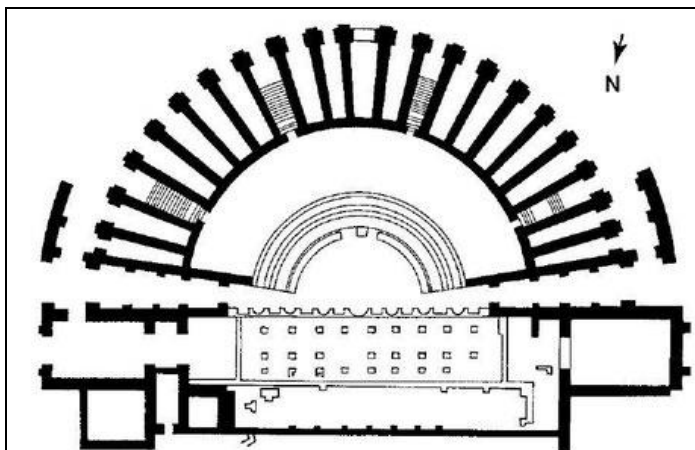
Plan du théâtre de Tipasa de Maurétanie
